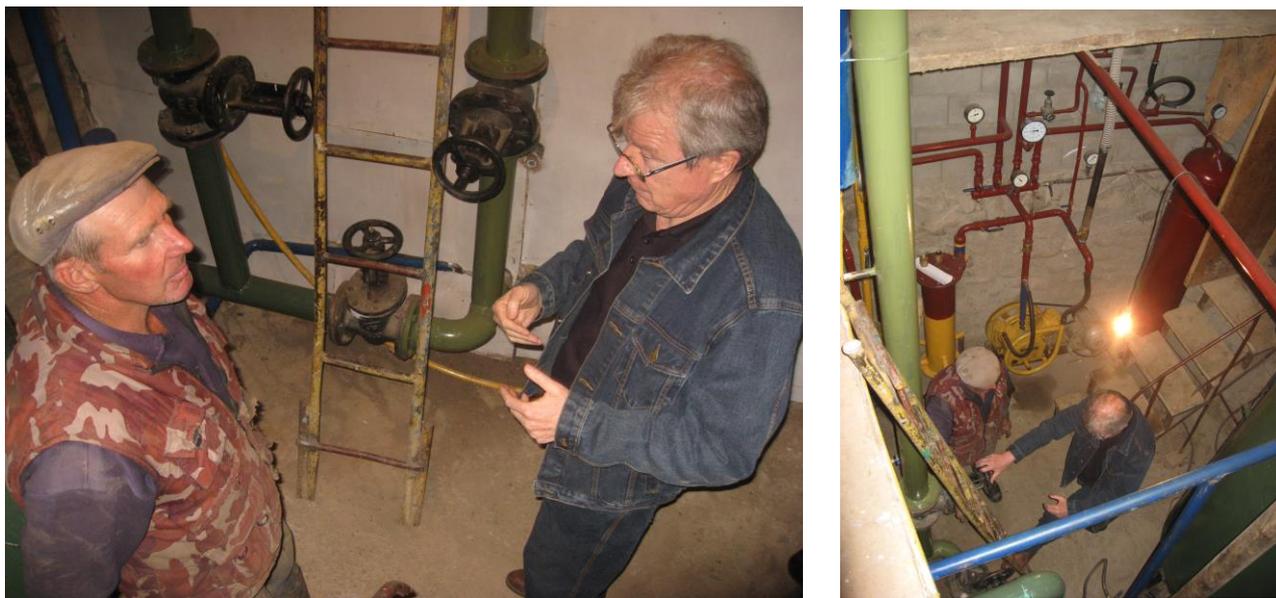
Внешний вид и схема биогазовой установки в с. Петровка
